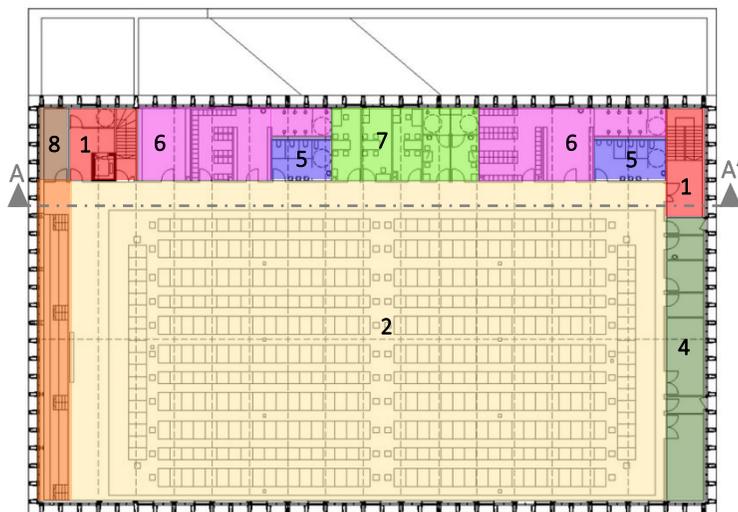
Planta baixa 2º pavimento, adaptada pela autora
